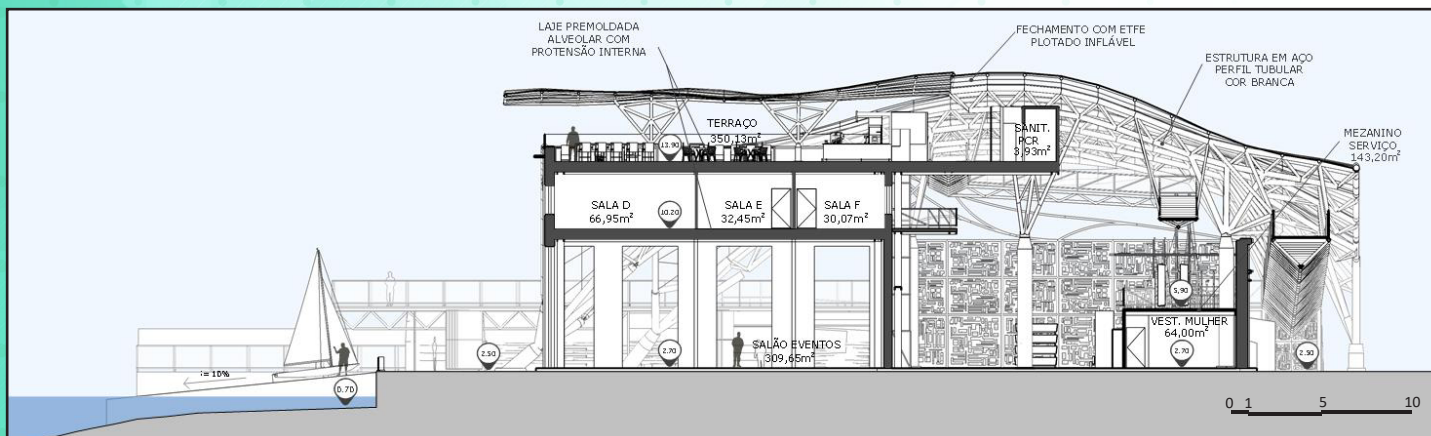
Corte CC. Planta técnica anexa em escala 1:200. Rafael Rodamilans, 2018
